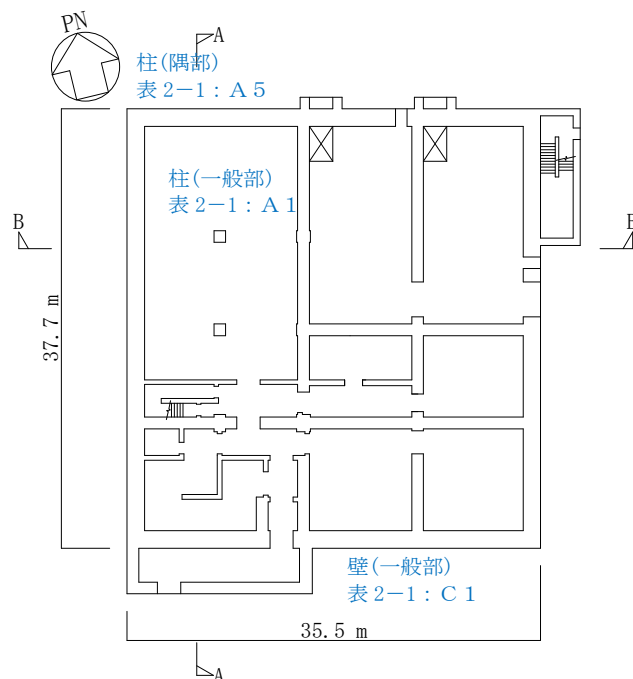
緊急時対策所建屋の概略平面図 (EL. 23. 3m)
